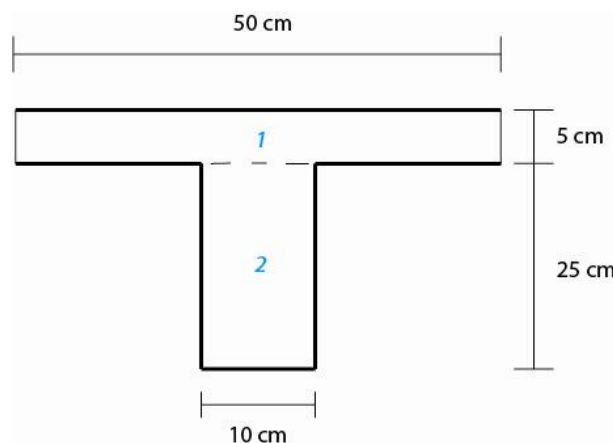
Vista en elevación de un solo nervio de losa alivianada.
